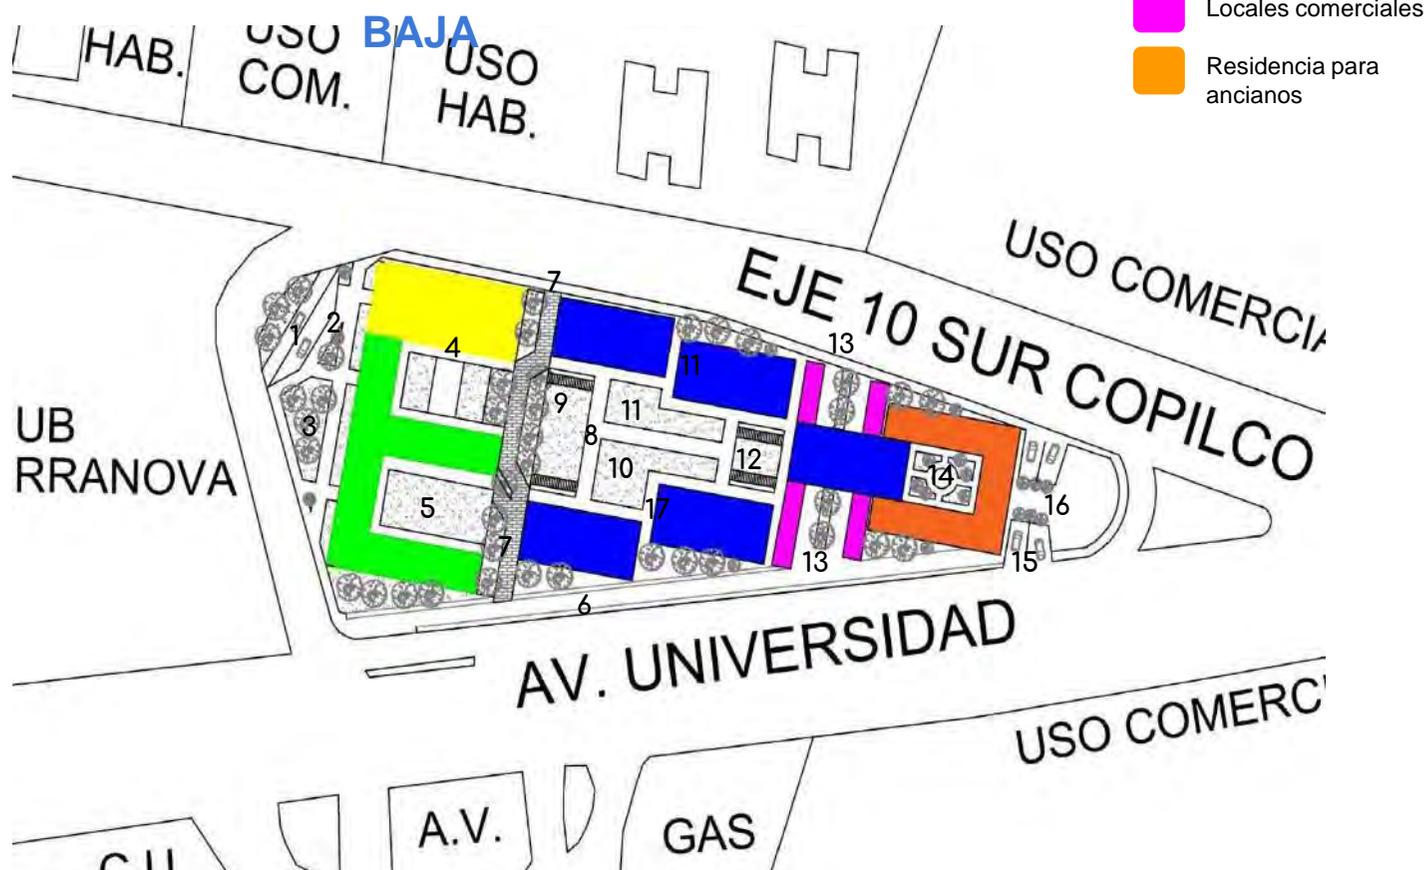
Tercera propuesta, ocupación planta baja. Elaboración propia, 2022
